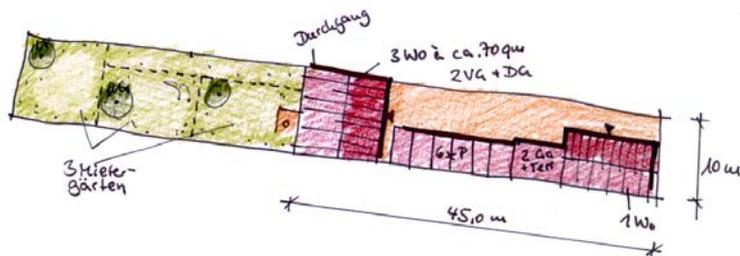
mögliche Bebauung – Vorstadtstraße 9, Variante 2
